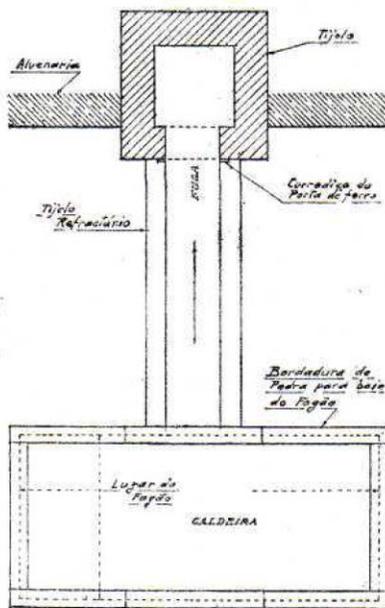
INSTALAÇÃO DE UM FOGÃO
